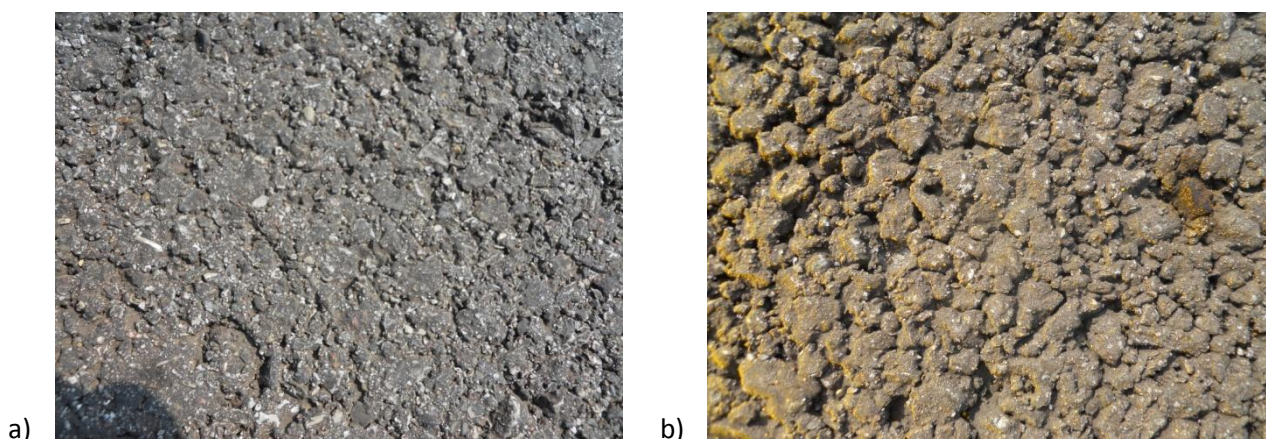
a) pavimentazione della zona Cargo Sud e b) pavimentazione del raccordo Charlie-Alfa.
